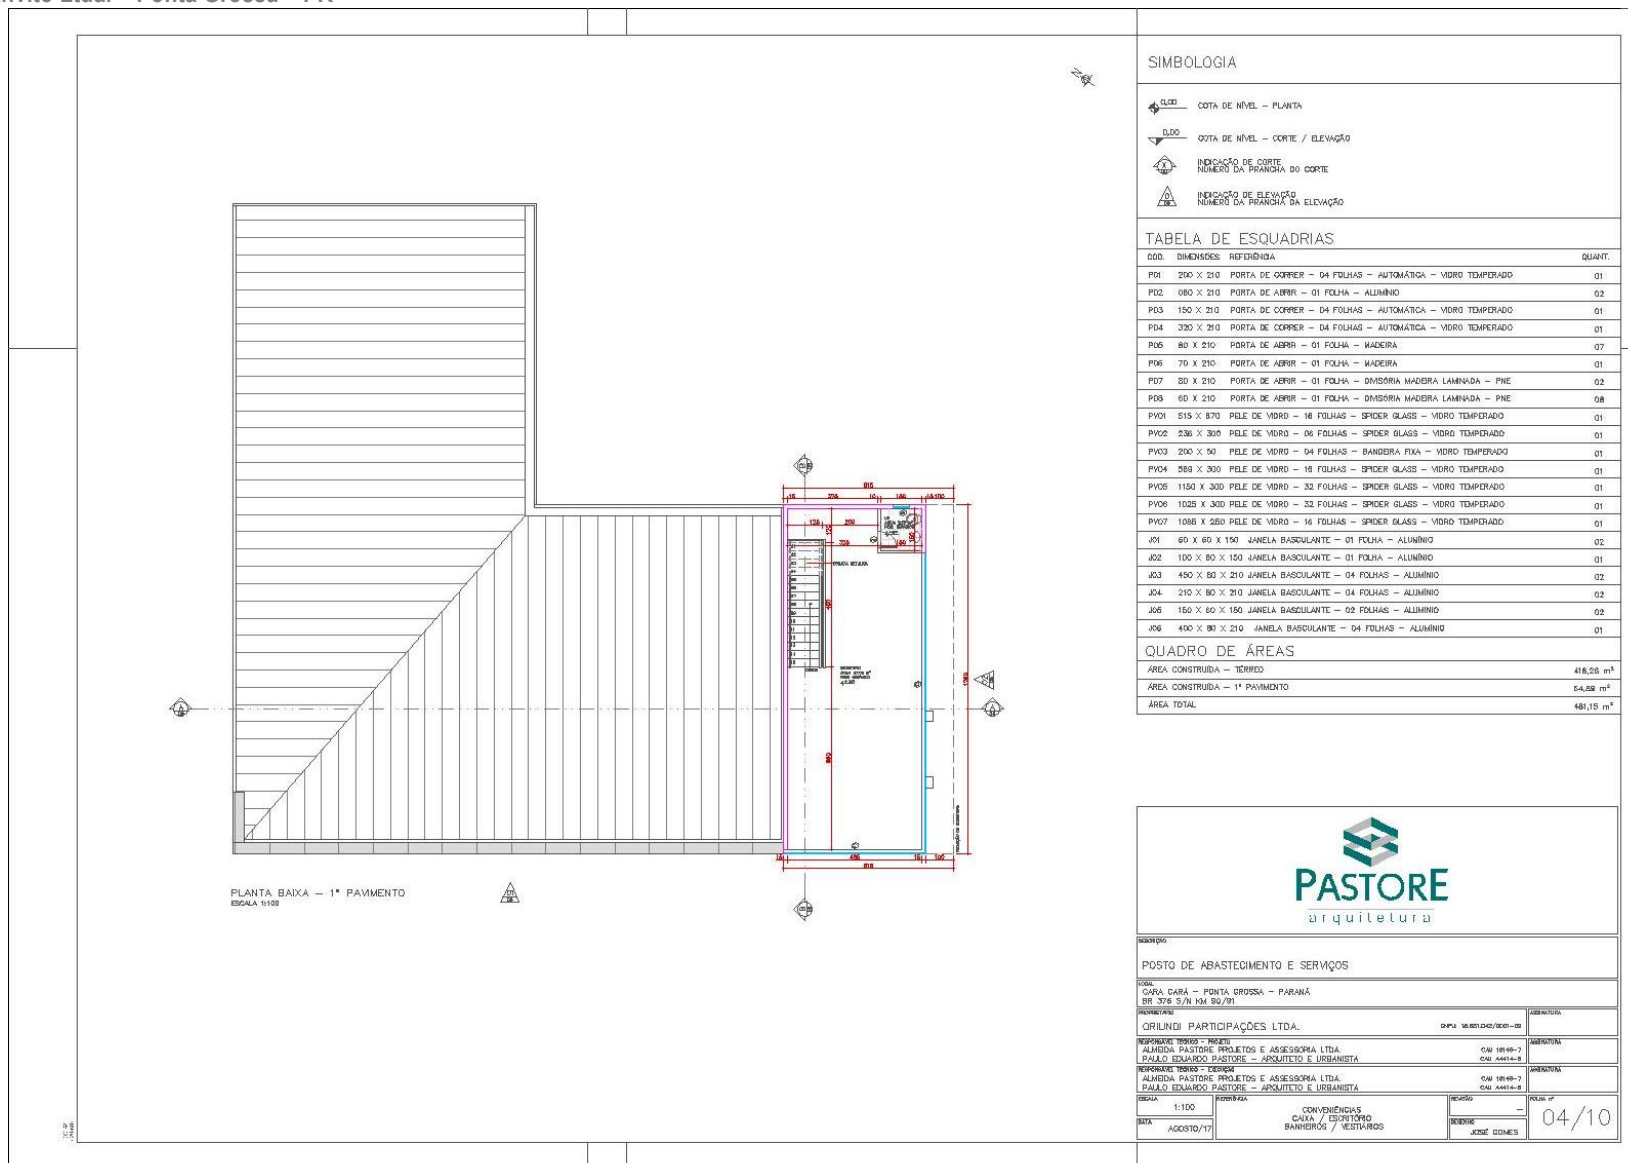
Planta baixa: conveniências, caixas, escritório, banheiros e vestiários.
